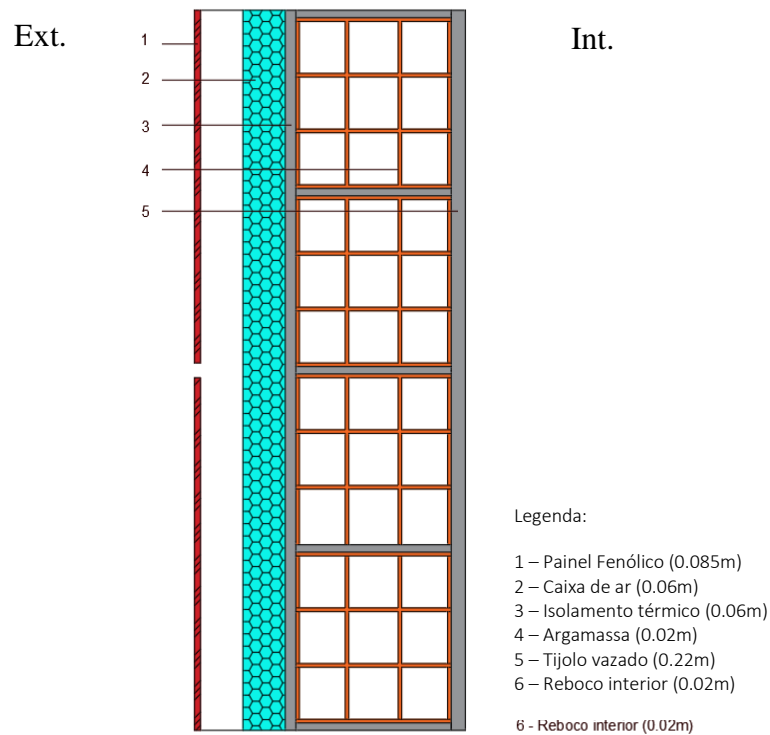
Pormenor construtivo referente à solução construtiva fachada ventilada
